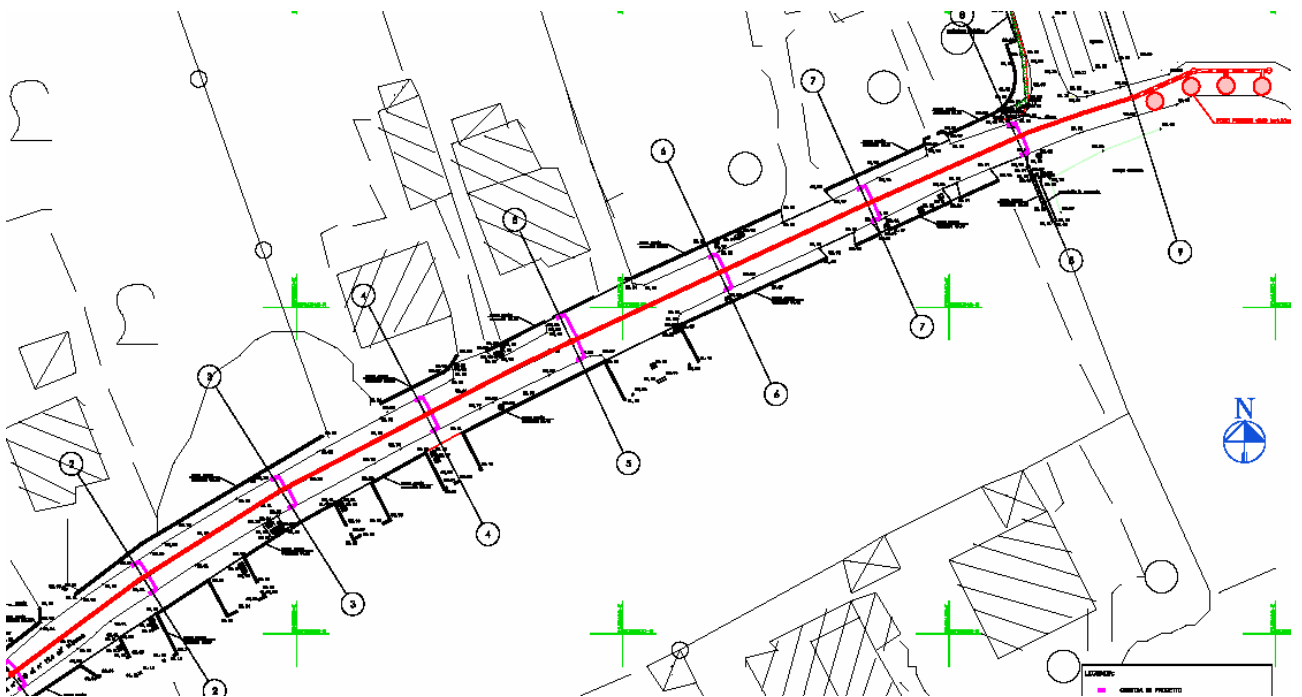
Planimetria di progetto della realizzazione della rete di raccolta delle acque meteoriche (intervento e).
